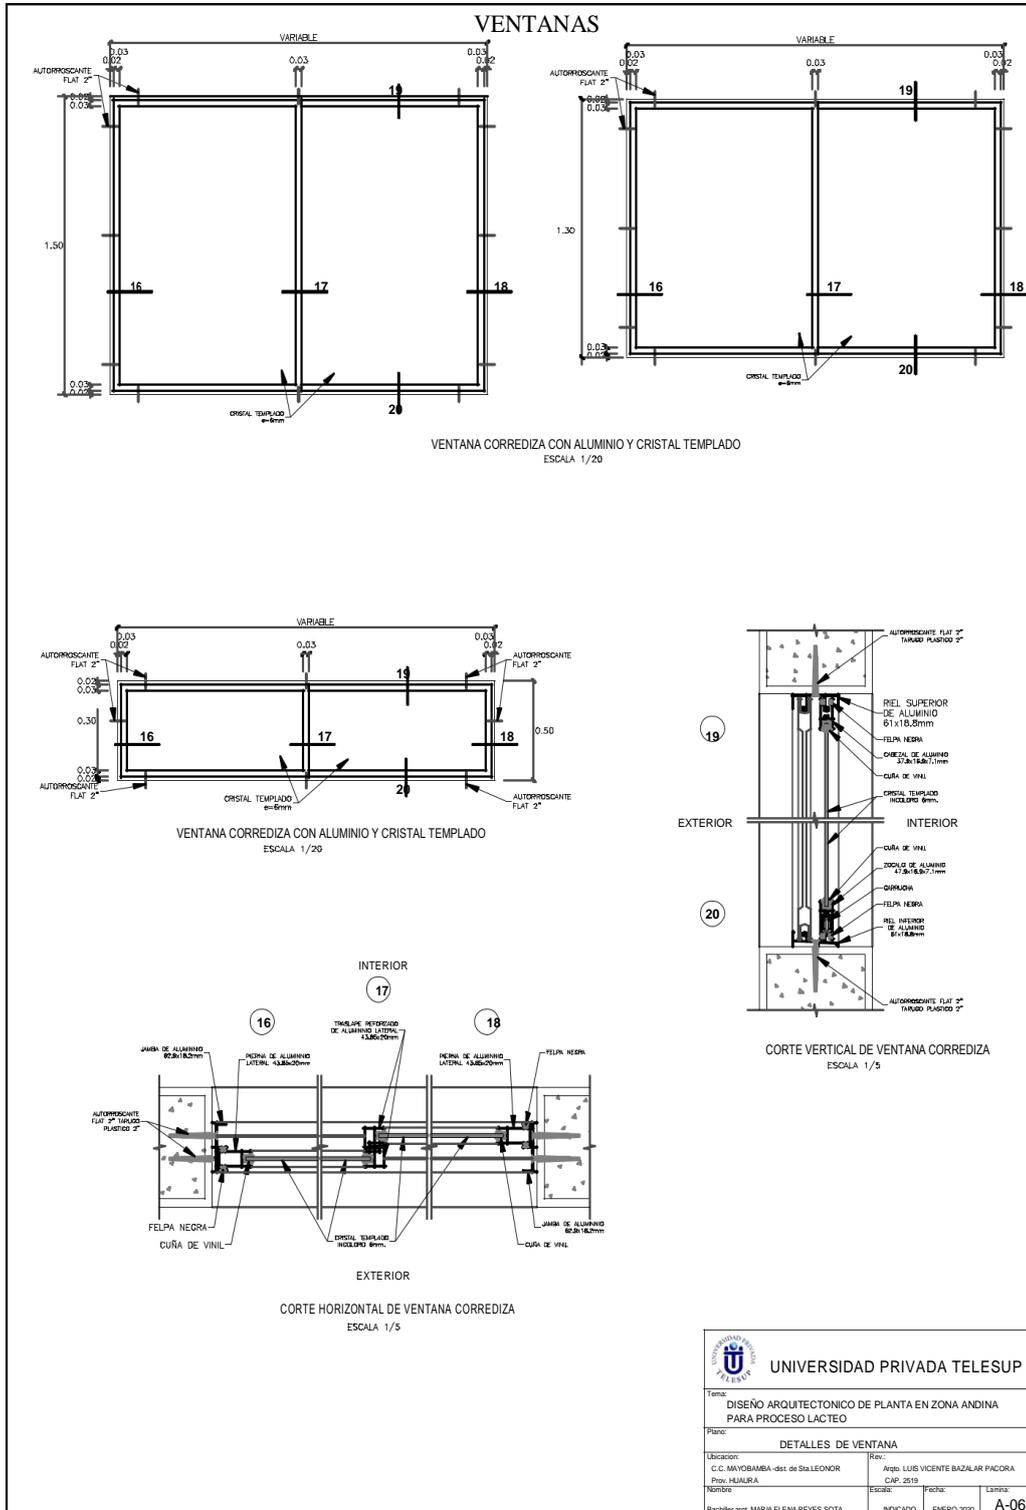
Plano de Detalles de Ventanas y Detalles Constructivos
